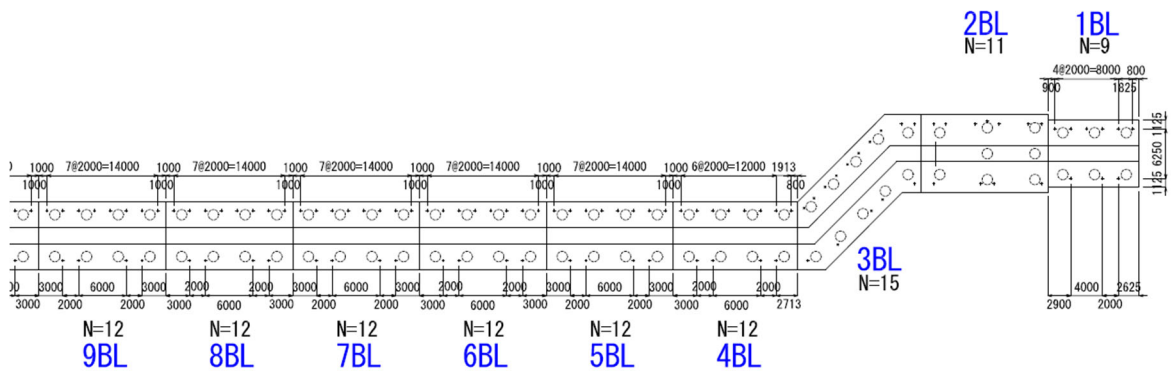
防波壁（逆 T 擁壁）の概略配筋図
